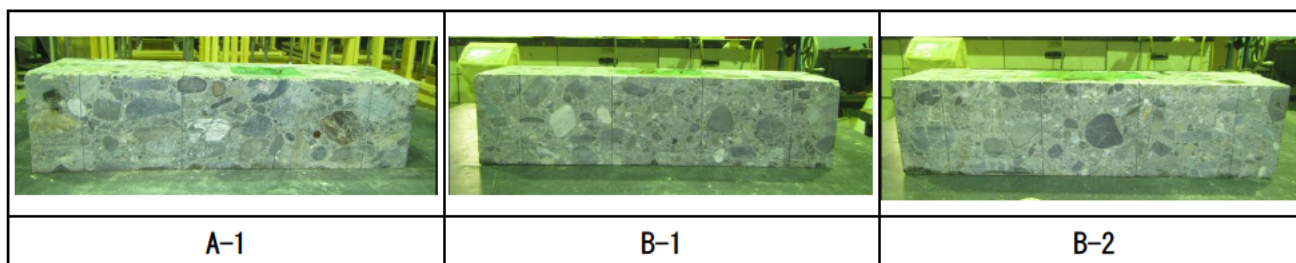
採取したコンクリート供試体（曲げ強度用）
